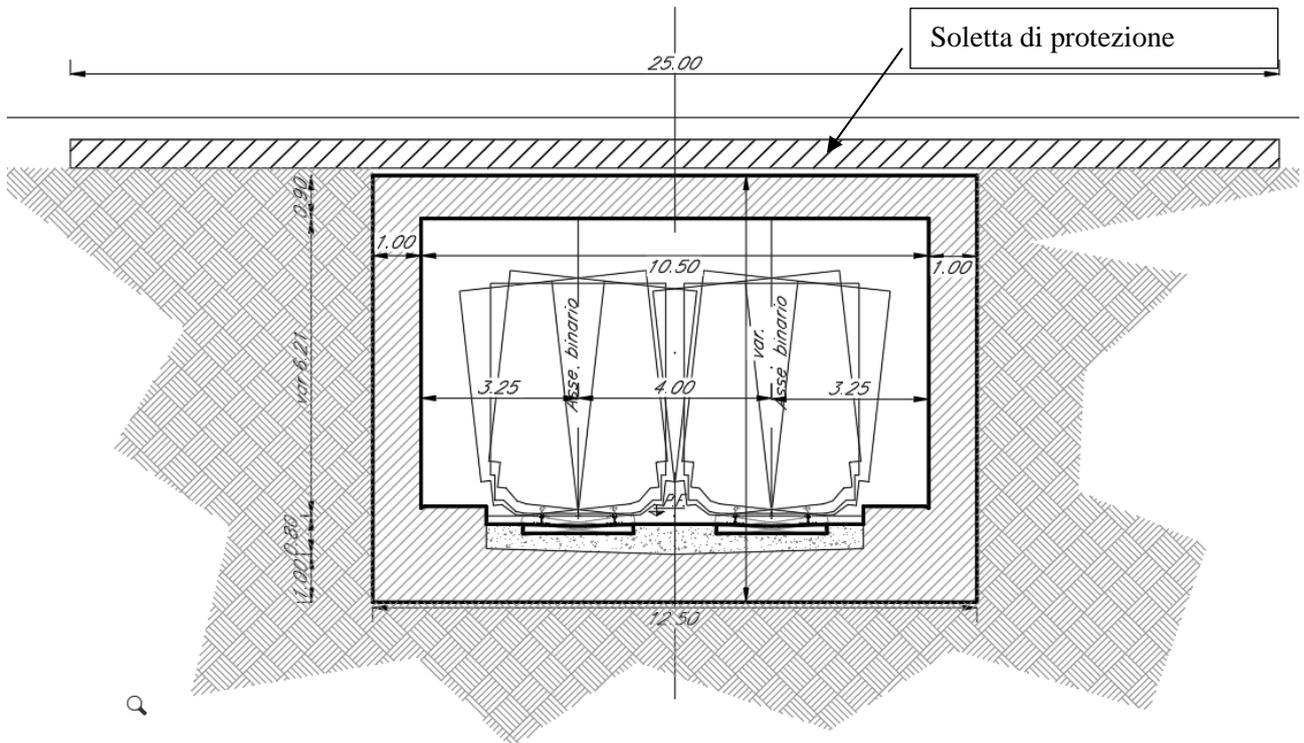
Sezione trasversale galleria artificiale spinta a pieno con soletta di protezione.
